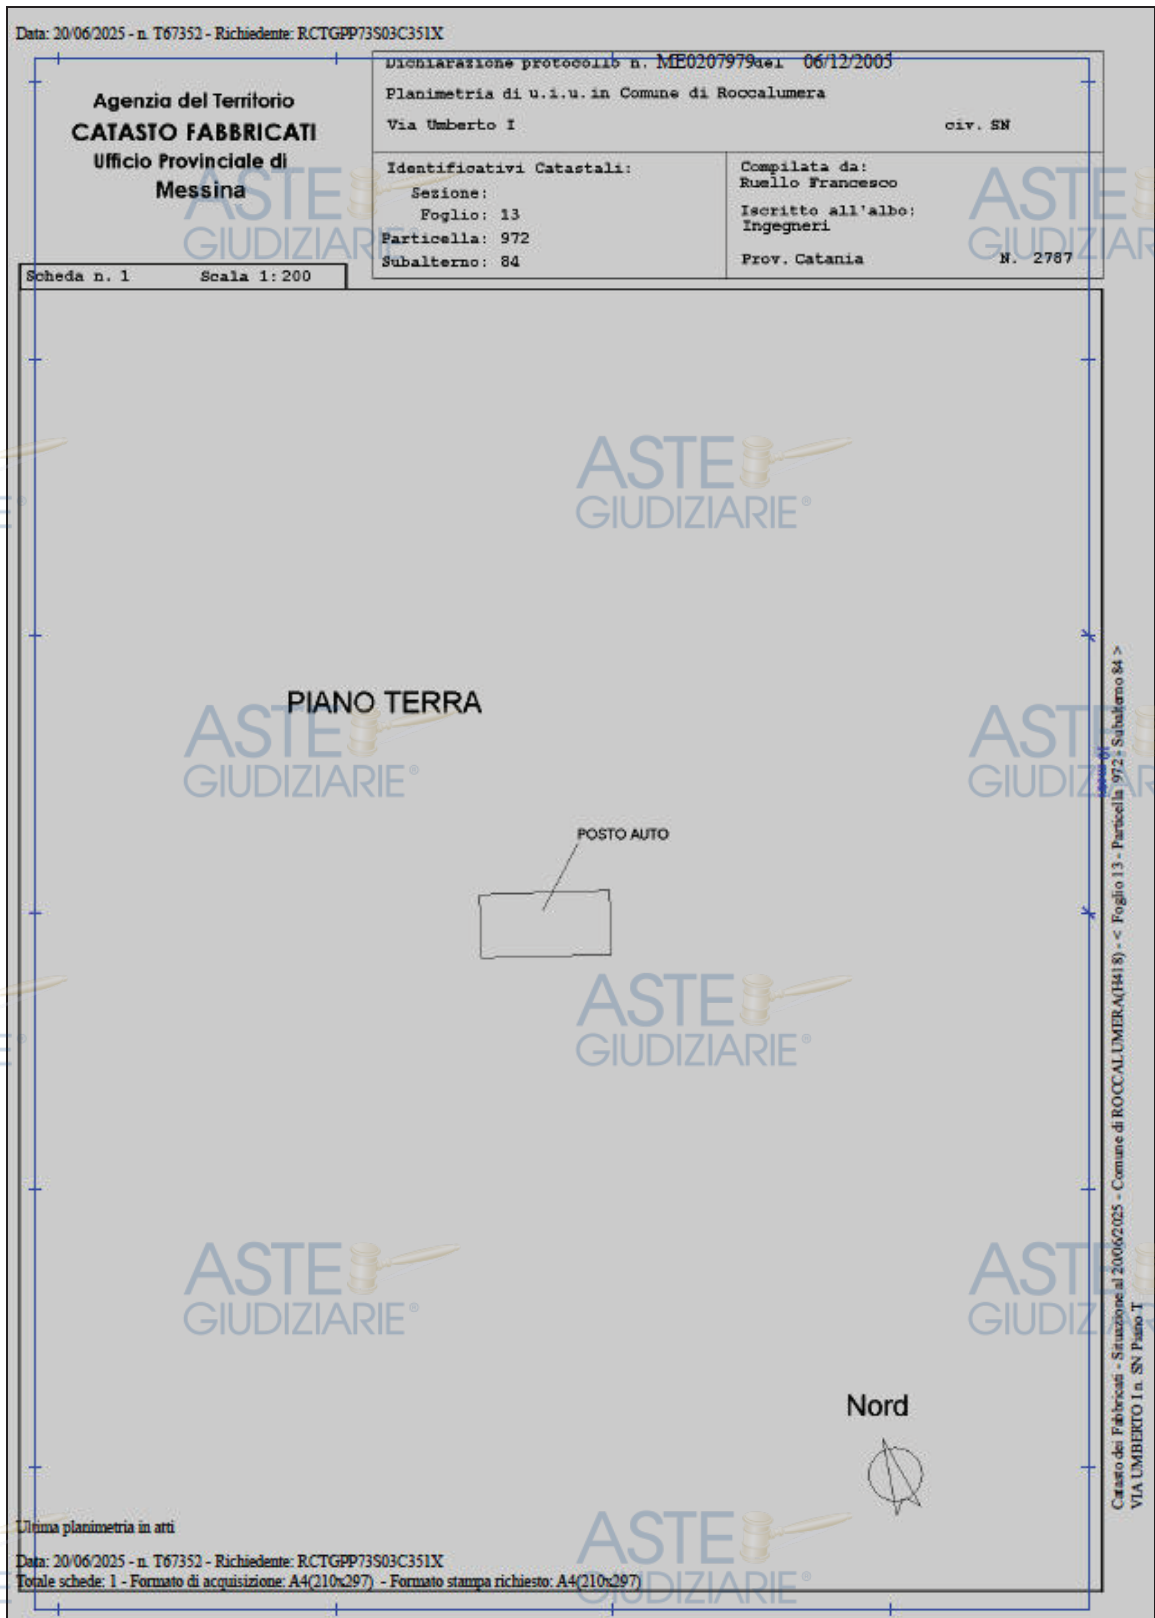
Visualizzazione della planimetria catastale del posto auto esterno individuato con il sub. 84
